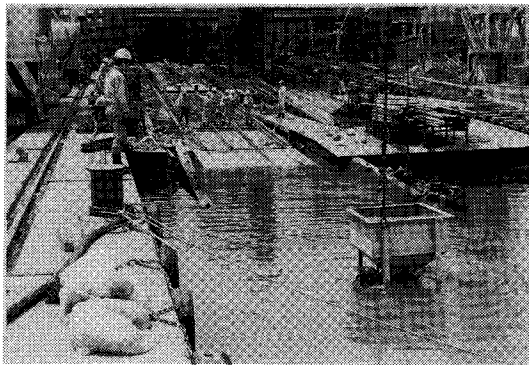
水中不分離性コンクリートを使用したスリップウェイの施工
